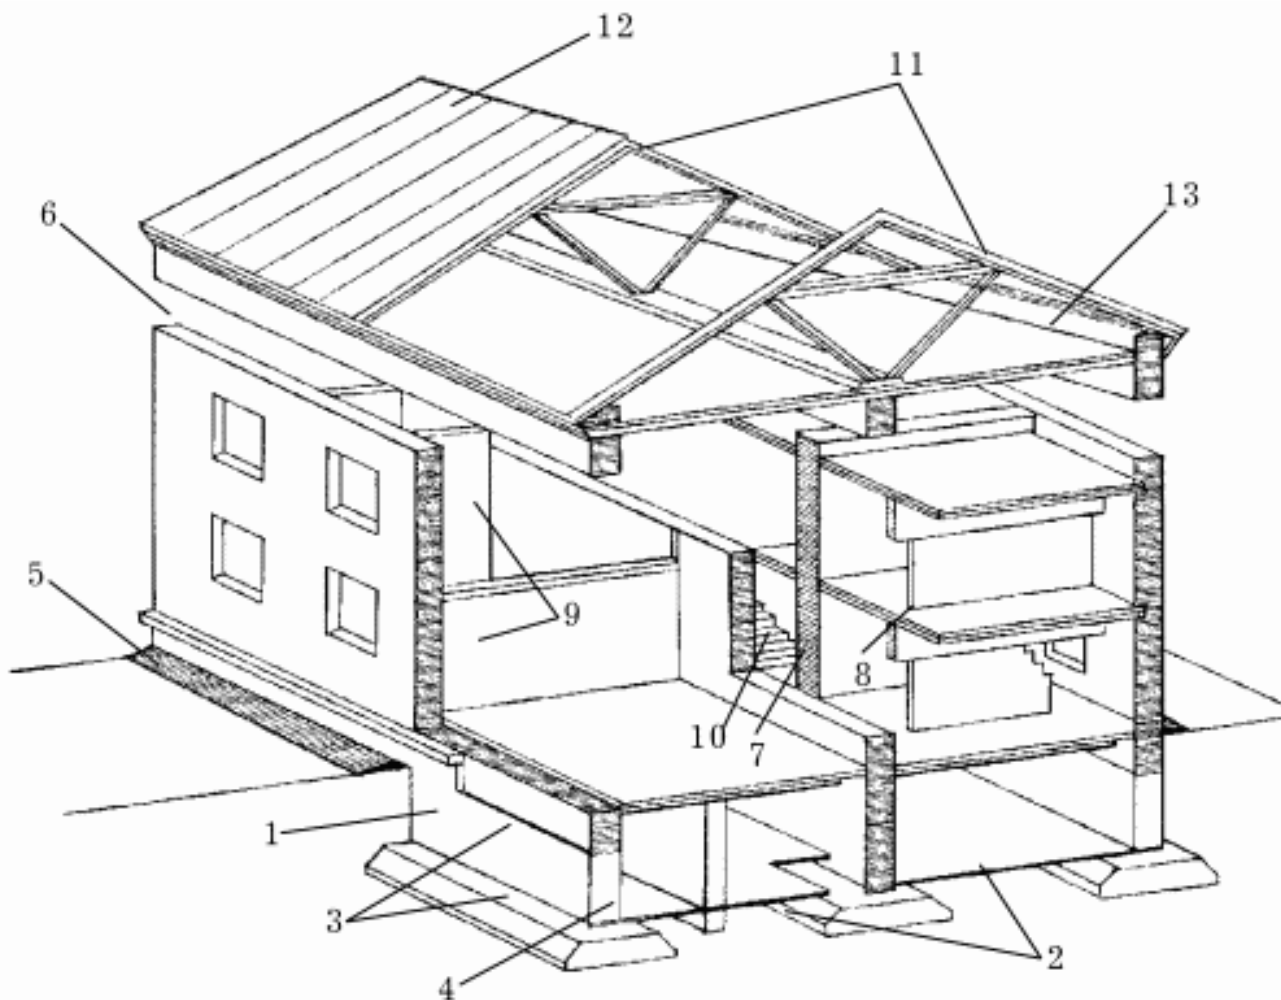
Схема двухэтажного дома: 1 – фундамент; 2 – пол подвала; 3 – гидроизоляция; 4 – стены подвала; 5 – отсodka; 6 – наружные стены; 7 – внутренние стены; 8 – междуэтажные перекрытия; 9 – перегородки; 10 – лестница; 11 – стропила; 12 – кровля; 13 – чердачное перекрытие.
